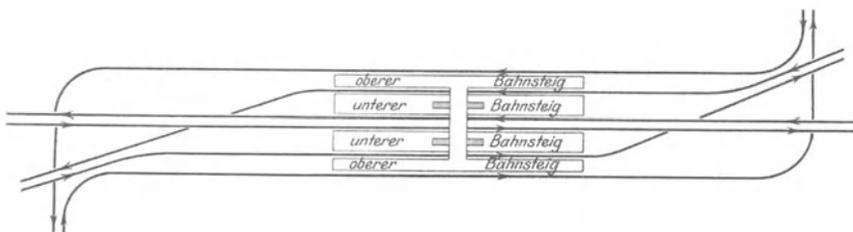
Kreuzungsstation dreier Linien. Zweigeschossige Anlage mit Richtungsbetrieb.
